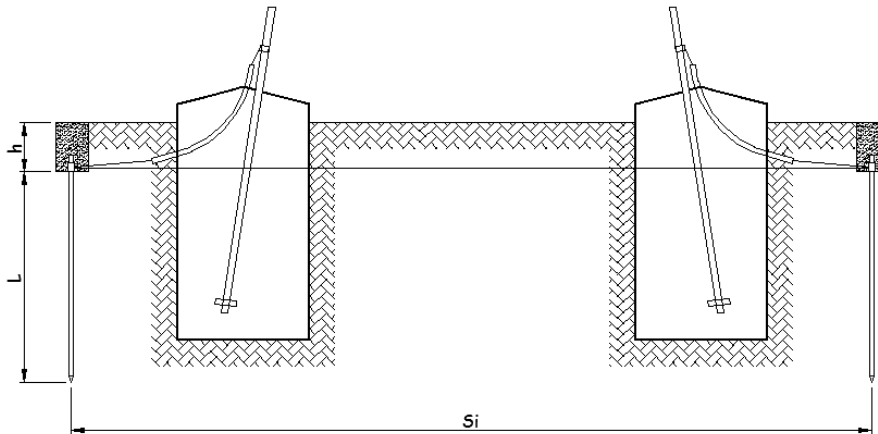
Detalle del perfil de instalación de puesta a tierra
